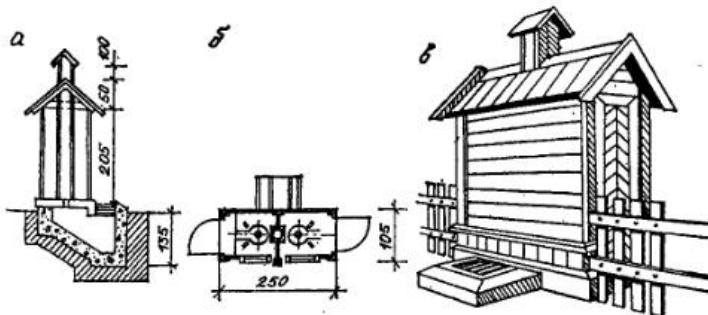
Дворовая уборная с бетонным выгребом: а — разрез; б — план; в — общий вид.
